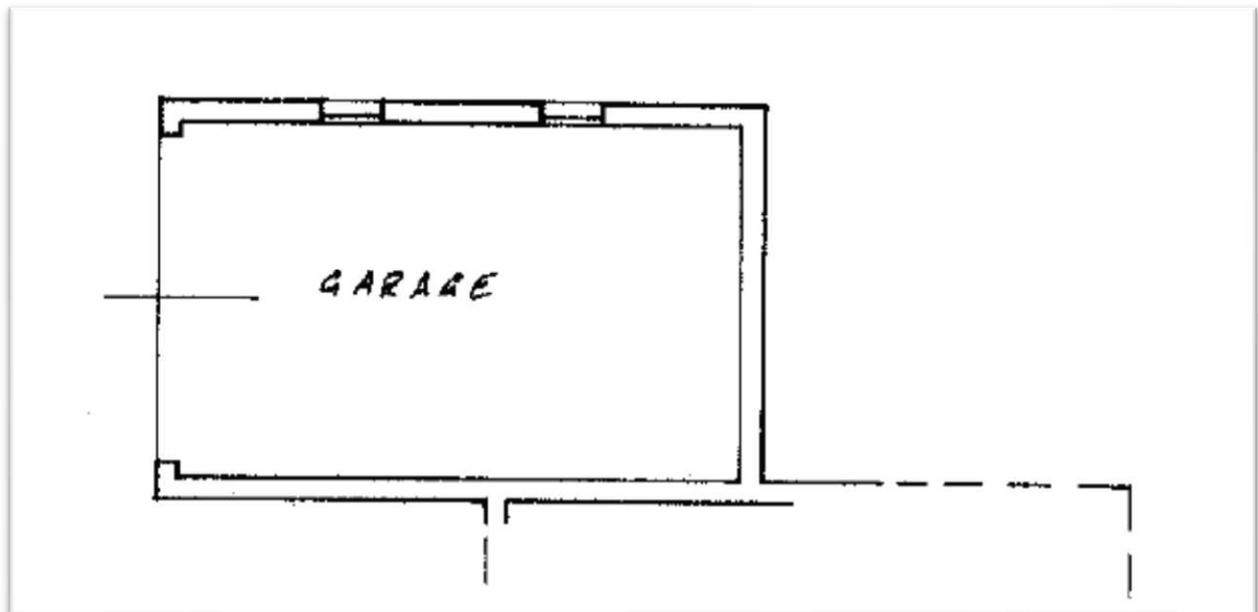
d: Estratto Planimetria catastale Mappale 315, Sub. 6
